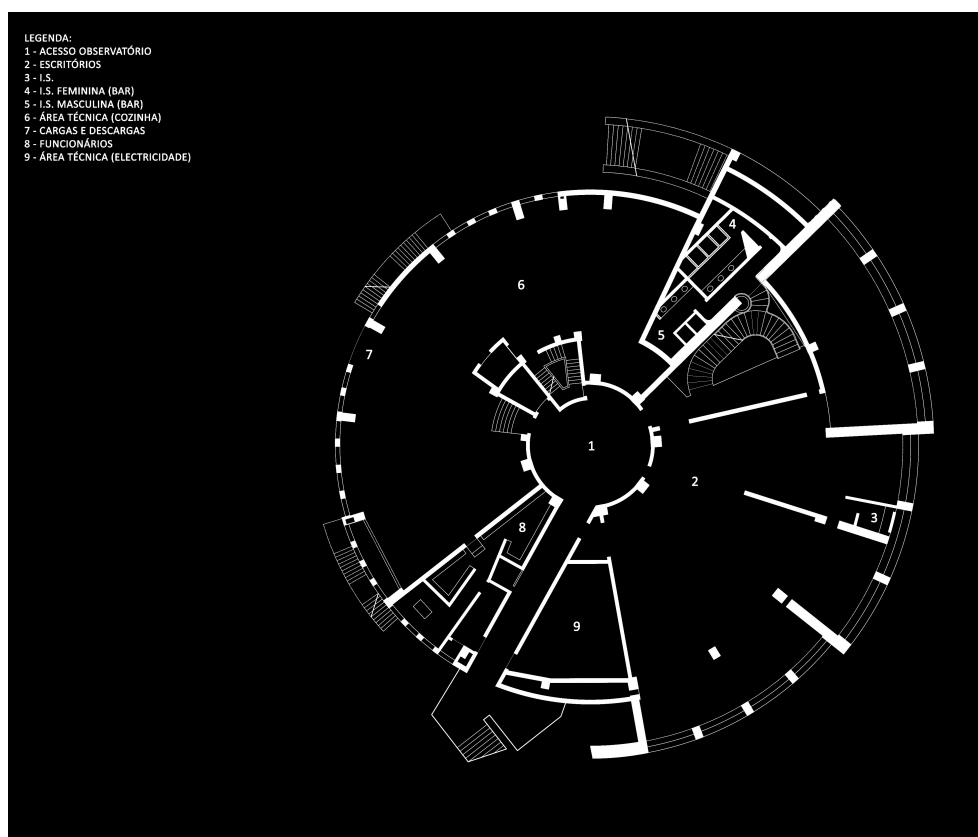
PLANTA PRÉ-EXISTENTE PISO TÉCNICO
